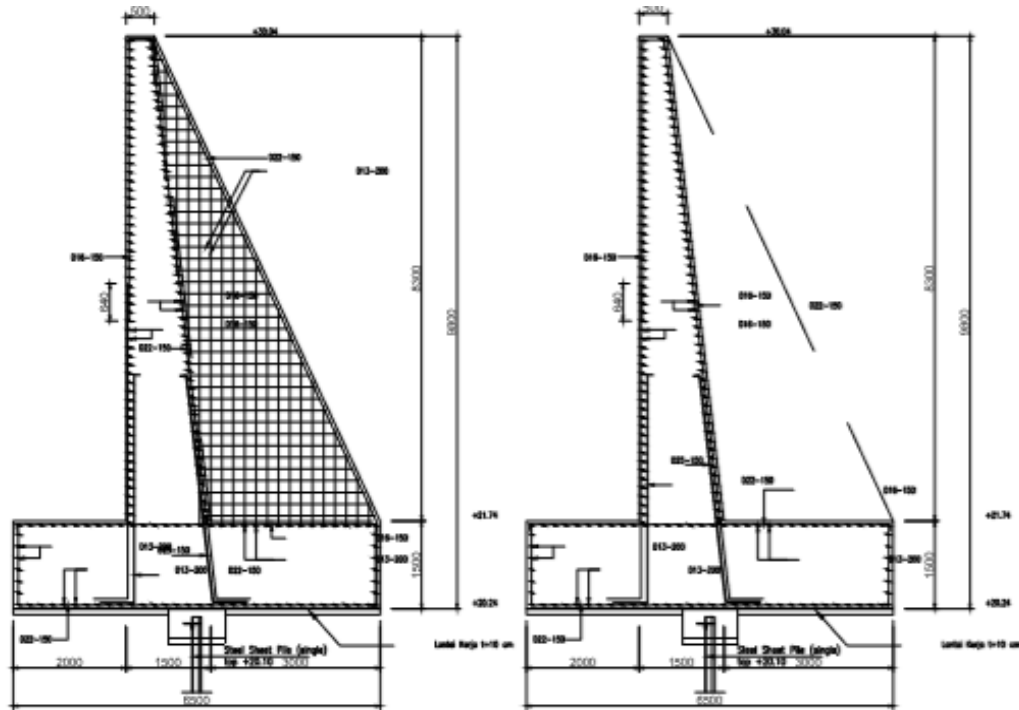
DETAIL PENULANGAN KONSTRUKSI DINDING PENAHAN TANAH TIPE A
